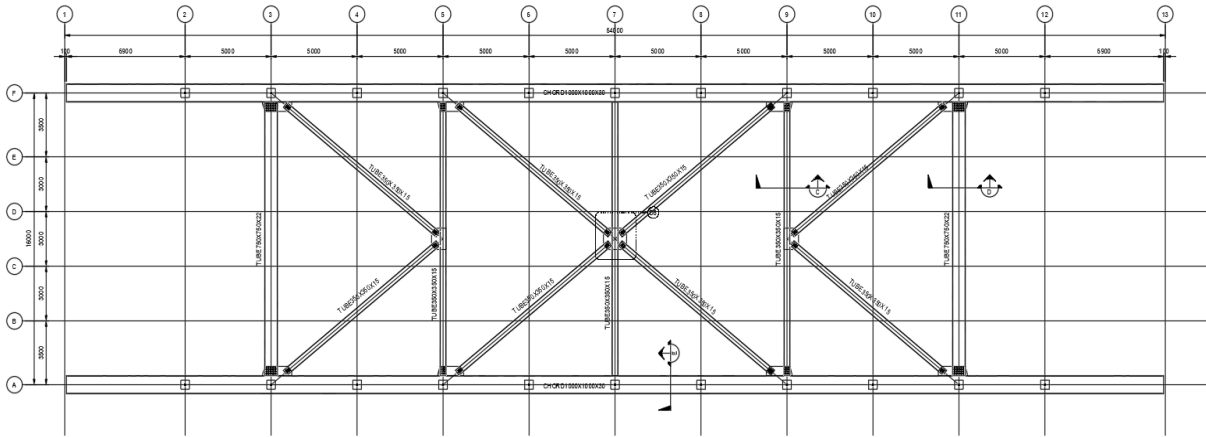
Vista em planta das cordas e do contraventamento do arco
